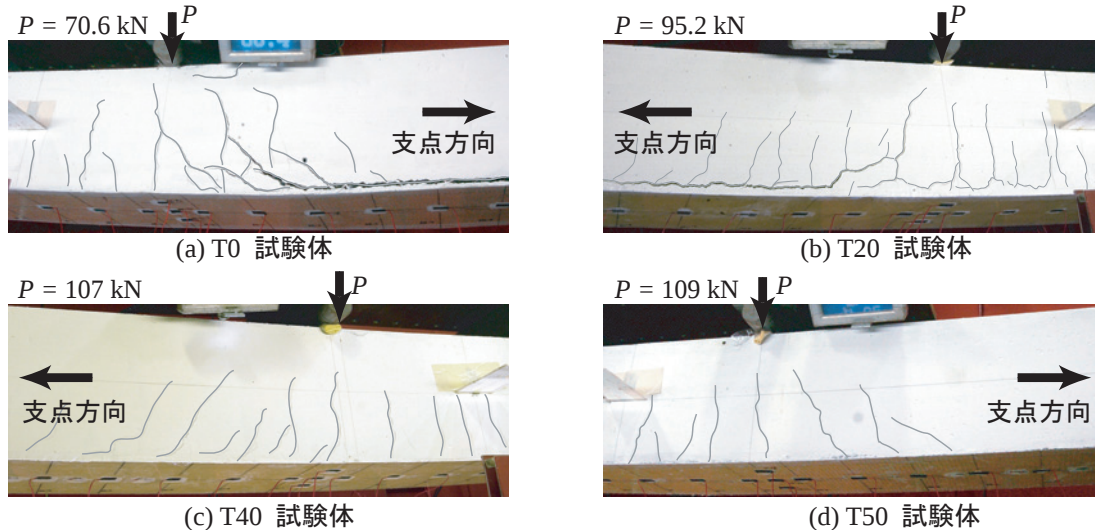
各試験体の終局時近傍におけるひび割れ性状
